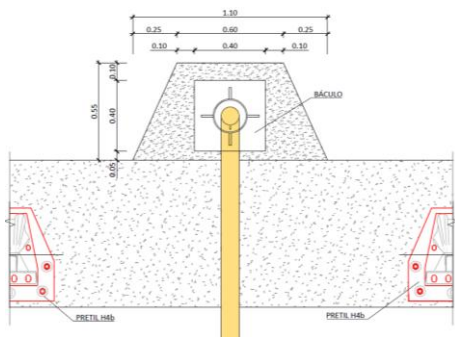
Planteamiento de ejecución de ménsula de hormigón para la colocación de báculos en estructuras.
